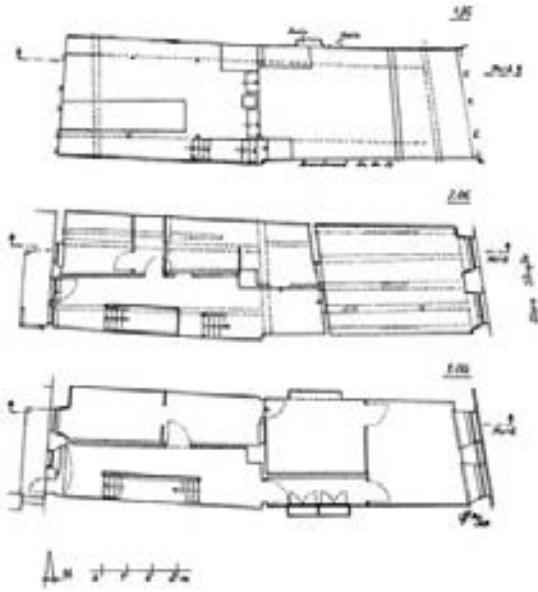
Villingen, Obere Straße 25. Grundrisse 1. DG, 2. OG und 1. OG, von oben.
